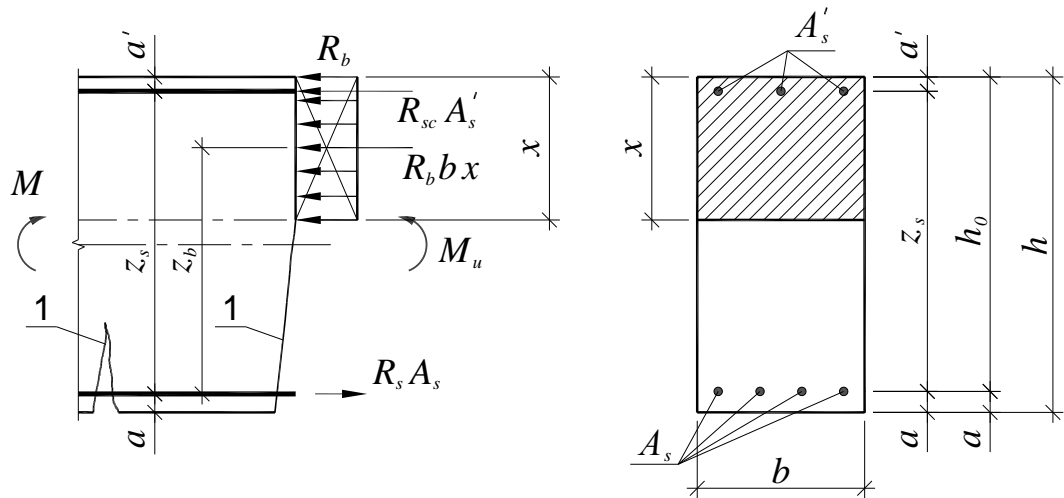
Расчётная схема элемента с двойной арматурой: 1 – нормальная трещина.
